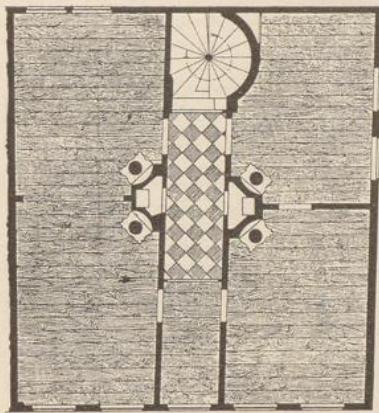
Vogel Strauss; Grundriss des I. Obergeschosses.
